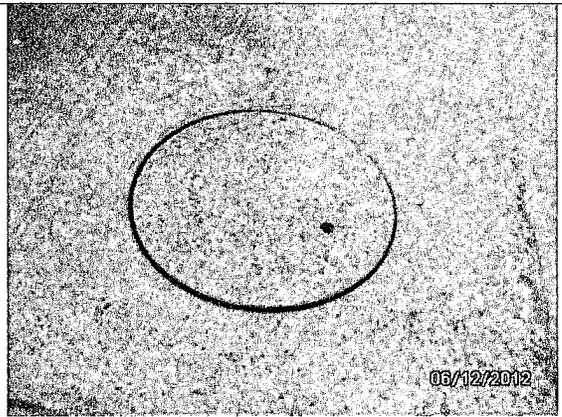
TAPA CÁMARA CON HORMIGÓN DEFICIENTE
